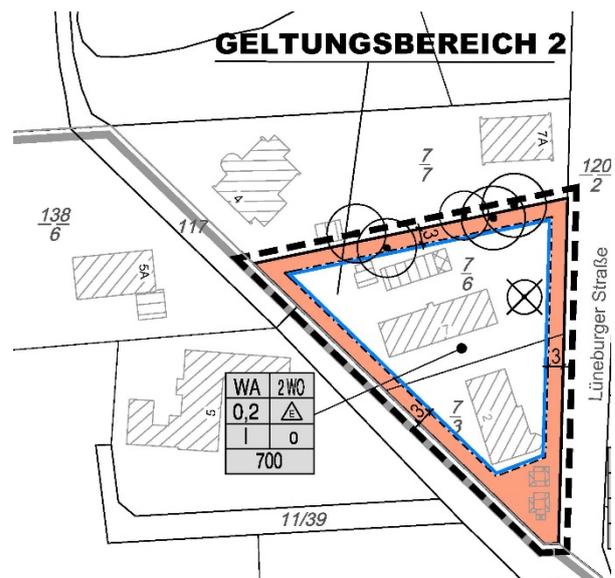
Ausschnitt B-Plan Nr. 16 „Altdorf“, 2. Änderung: Geltungsbereich 2
